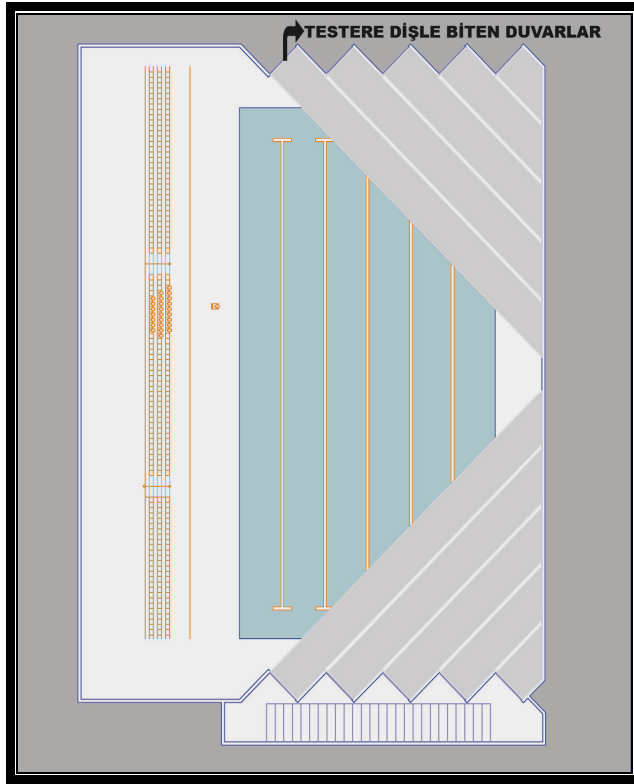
Duvar ayırıcı elemanları planı [12]
